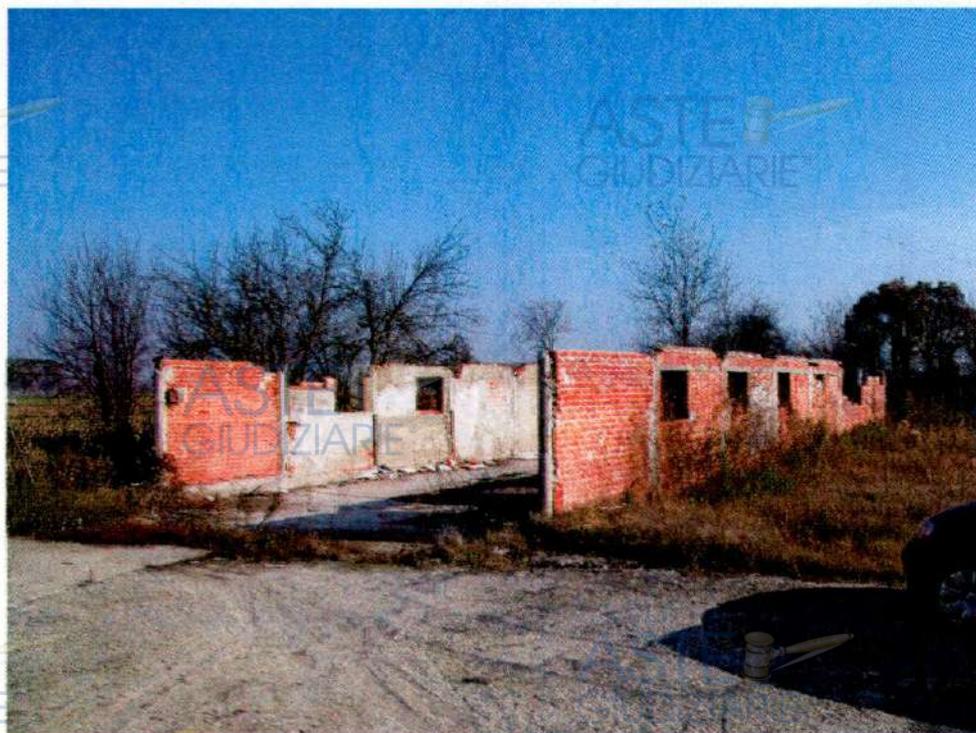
Vista dell’abitazione (sub.2) e del magazzino ex stalla (sub.3) dalla corte
